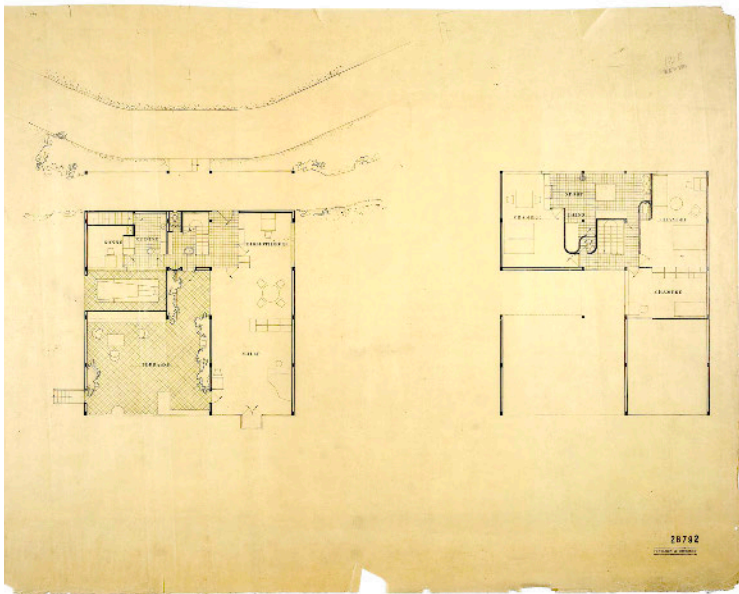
Plantas versão previa do Pavilhão L'Esprit Nouveau. Documento FLC 28792.
